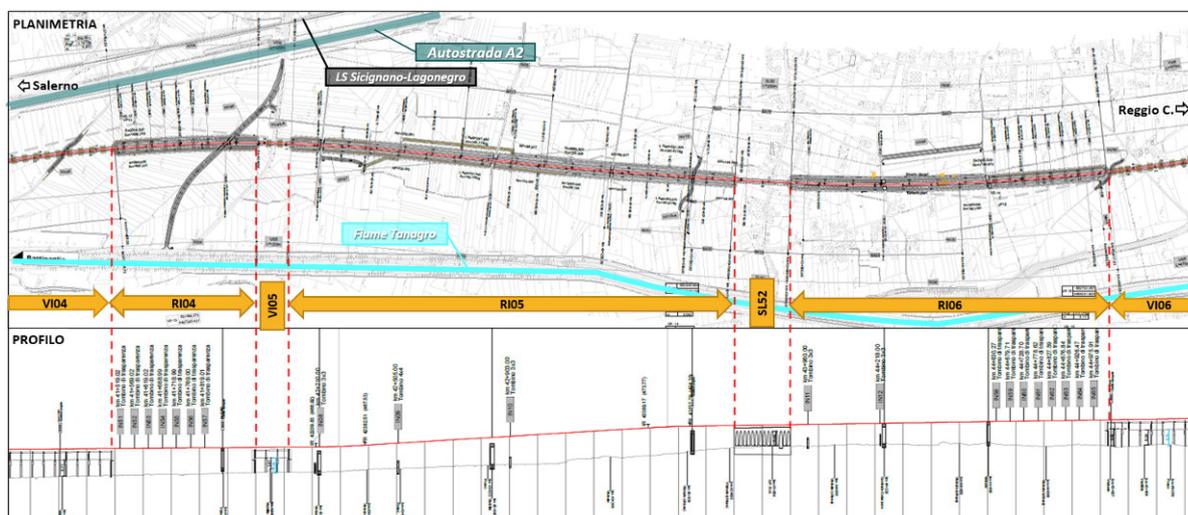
Planoprofilo di progetto da km 39+300 a km 41+486
